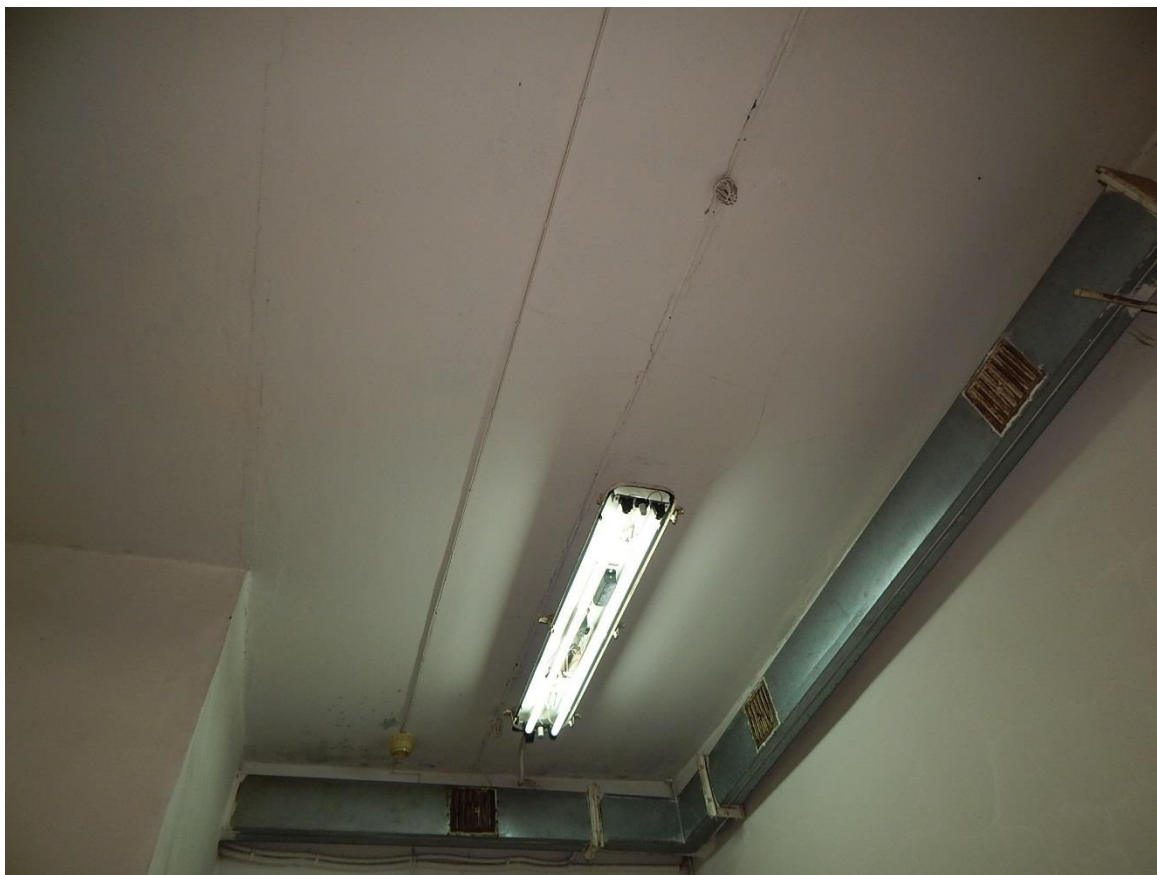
Внешний вид плит междуэтажного перекрытия в помещении разде-
